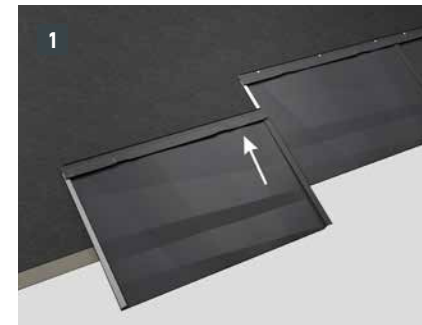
Panel dachowy FX.12 - Przykład montażu, wariant 2
